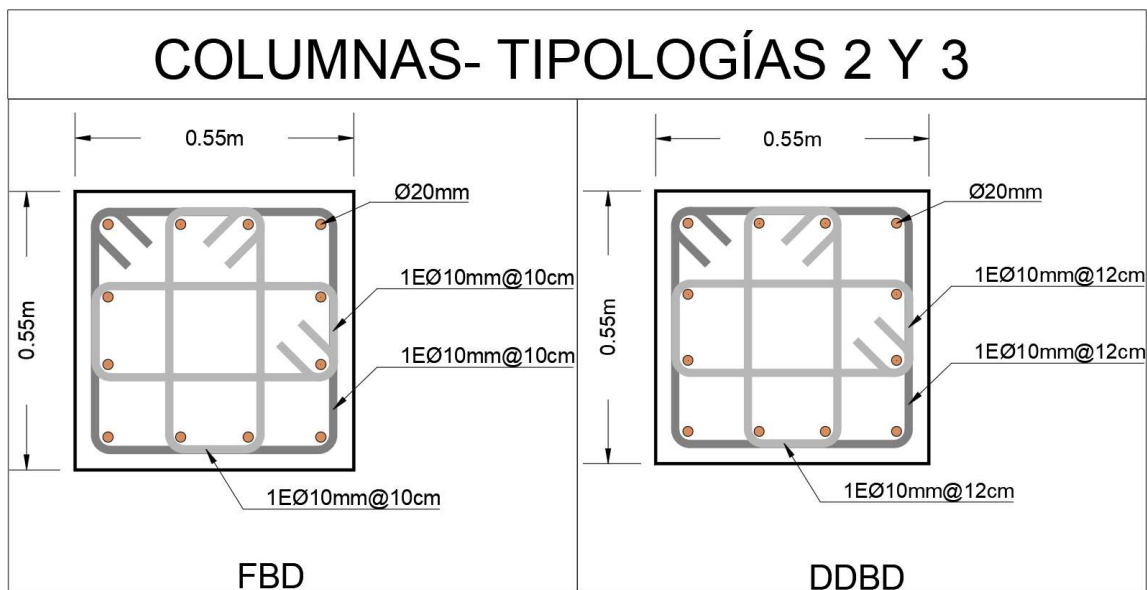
Esquema de columnas tipologías 2 y 3
